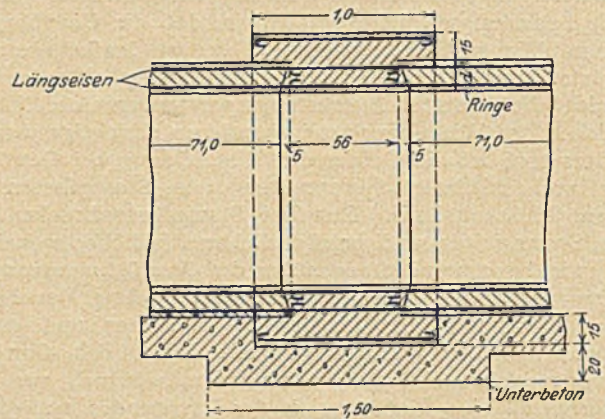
Schlußring zwischen zwei Teilstücken des Rohrstrangs.
